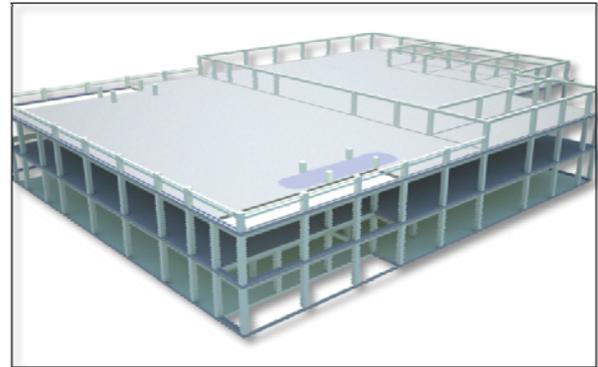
Elementos estructurales usados en el proyecto, principalmente columnas de concreto.
